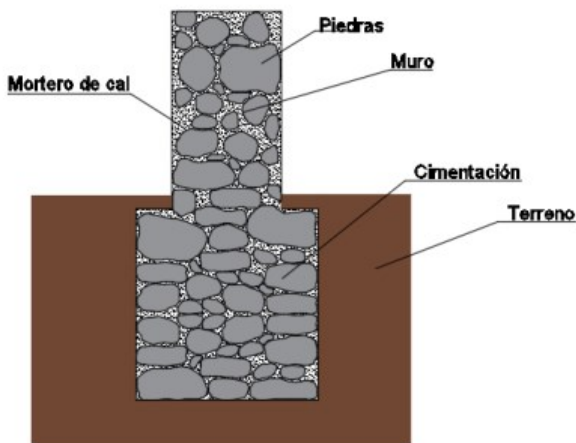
Detalle tipo cimentación. 2016. Fuentes propias
